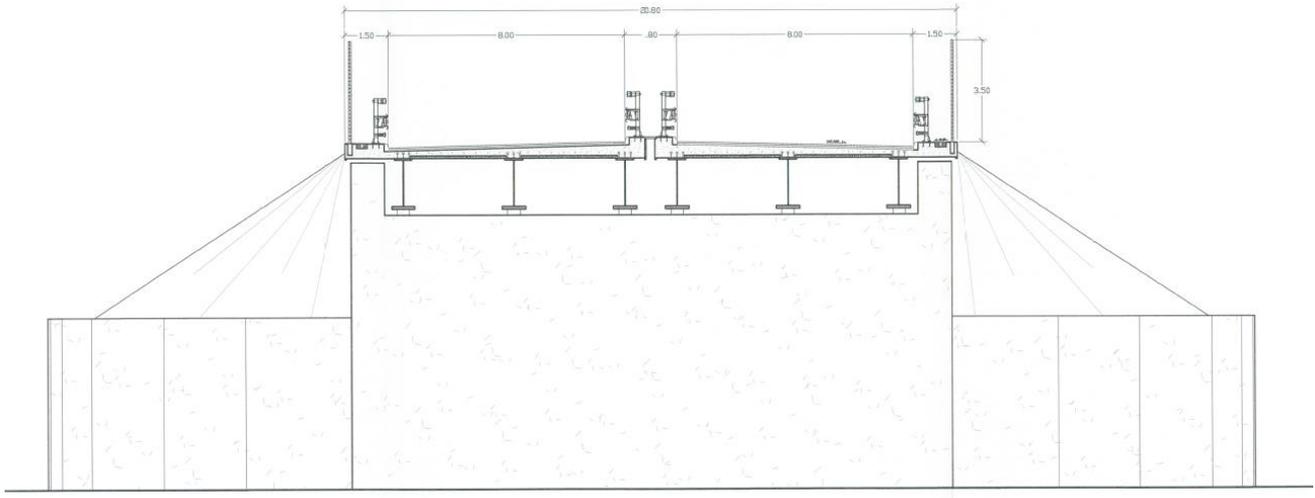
Sezione trasversale cavalcaferrovia IV15 nel progetto approvato
